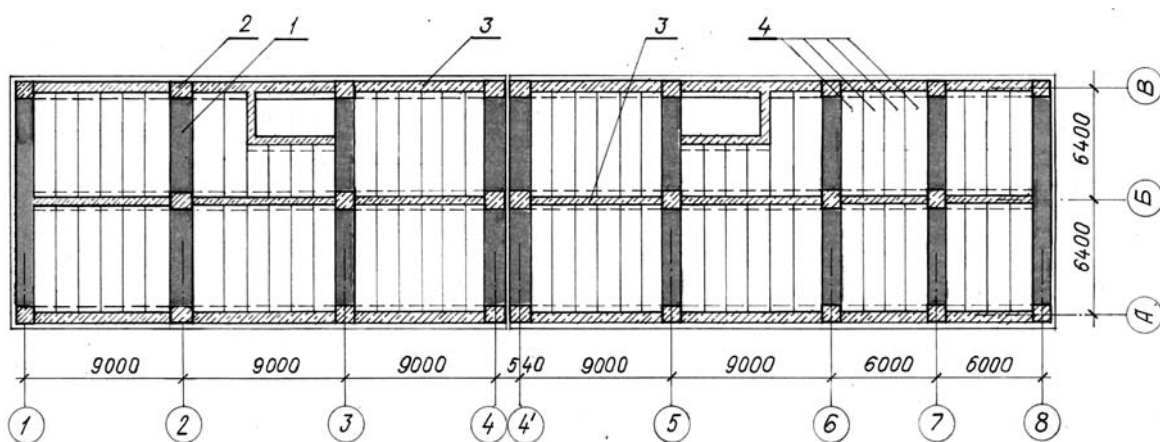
План-схема монолітних залізобетонних контурів у рівні перекриття першого та другого поверхів:
